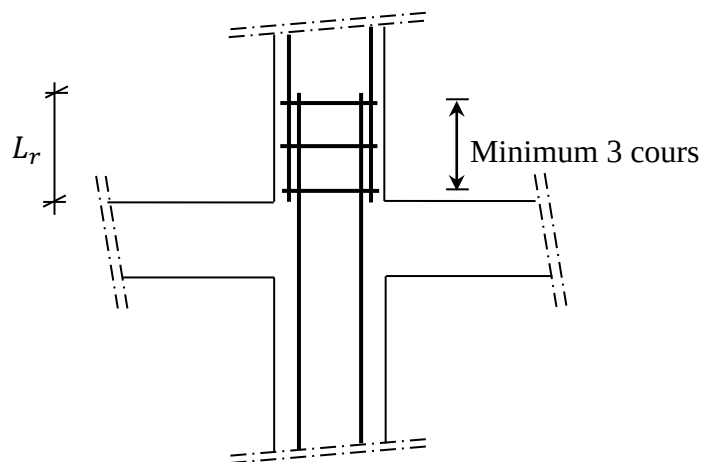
Les armatures transversales dans la zone de recouvrement
